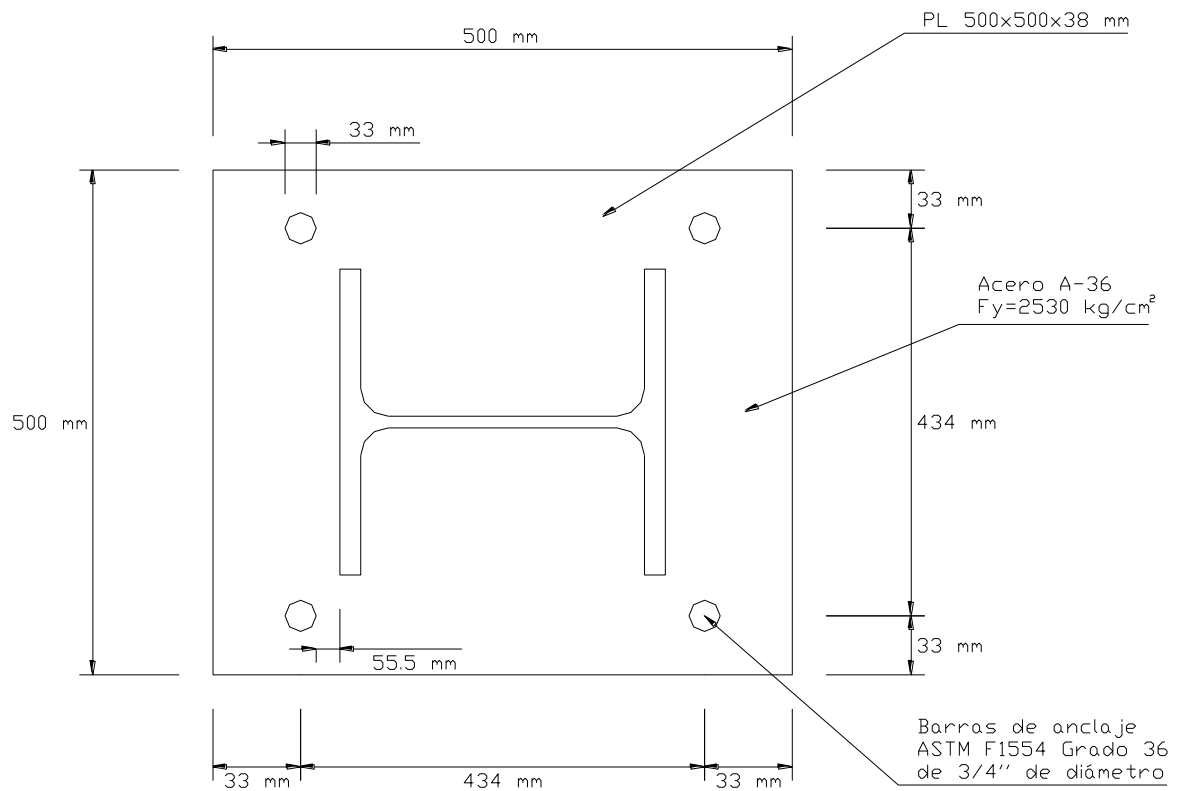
Detallado en Planta del Ejemplo 6.
